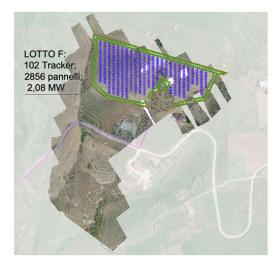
Particolare Layout di impianto area F su stralcio rilievo
